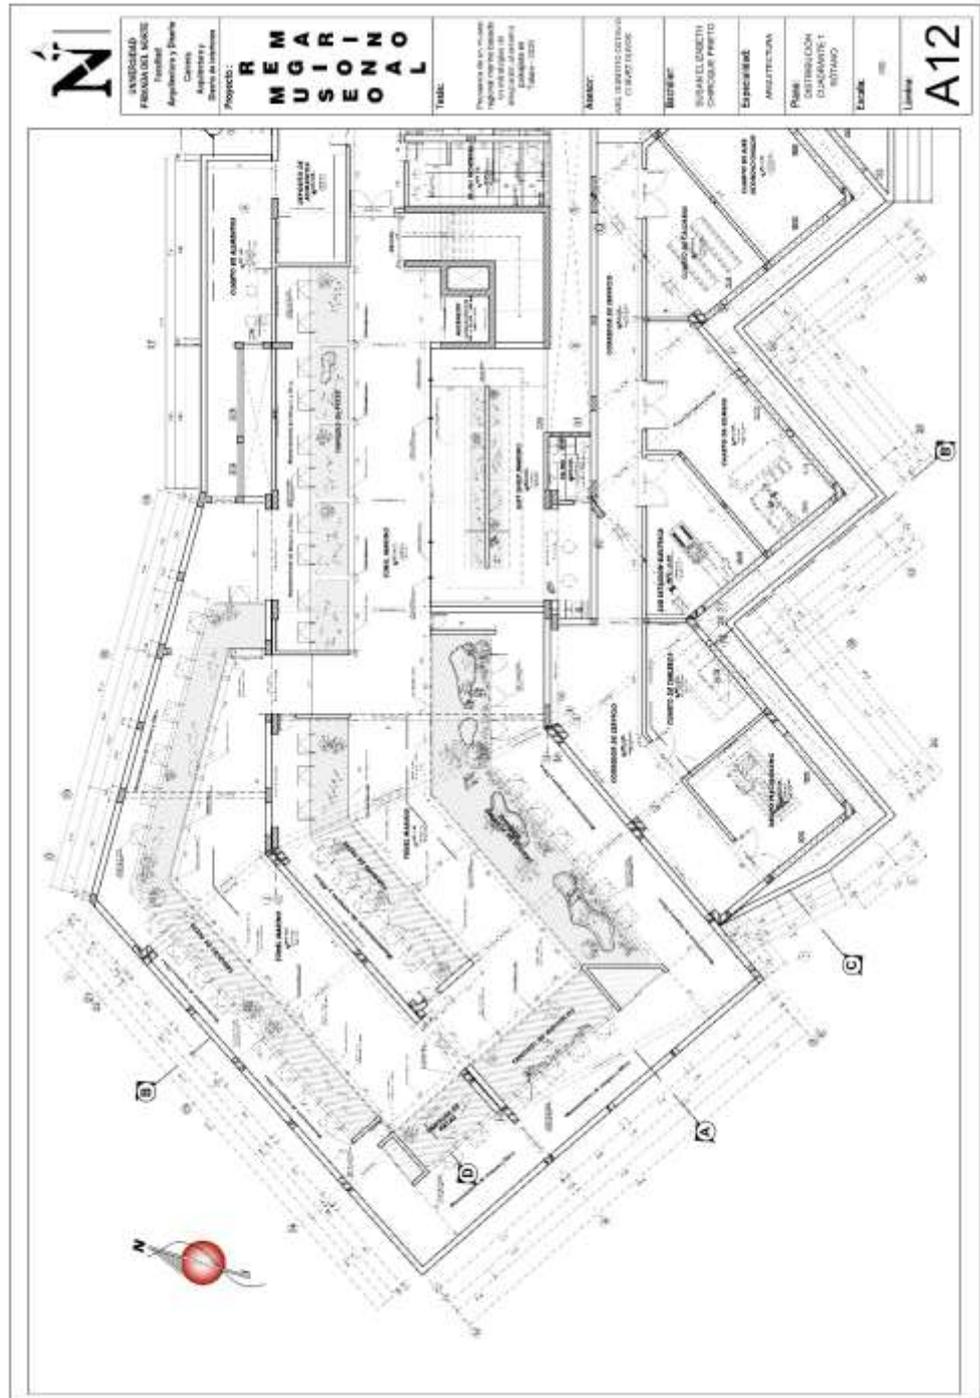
Distribución a detalle sector nivel sótano primer cuadrante.
